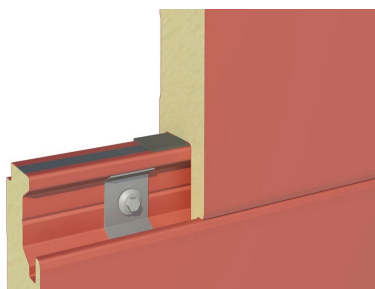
Detalle de fijación para los paneles de fachada tipo sandwich.
